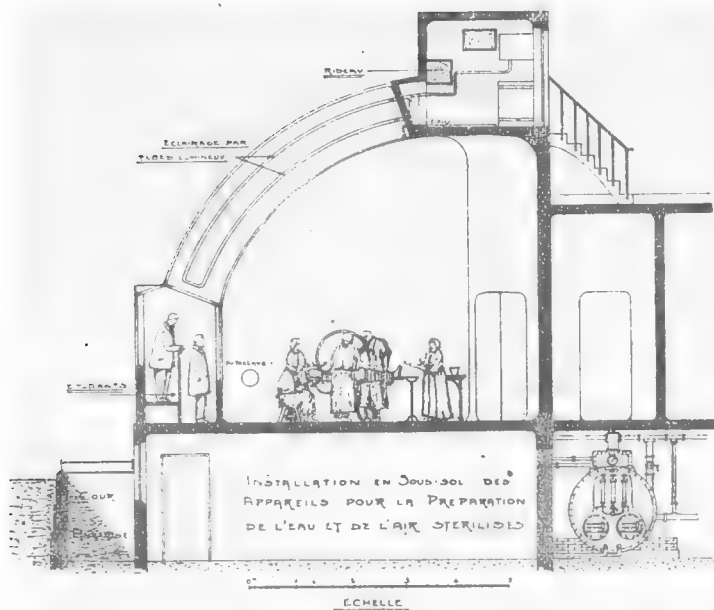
Coupe sur la salle d'opérations : coupe longitudinale sur une salle d'opérations.
